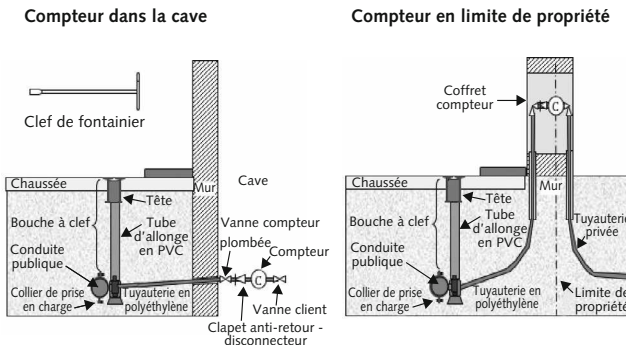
Prise sur conduite en tranchée avec robinet sous bouche à clef
